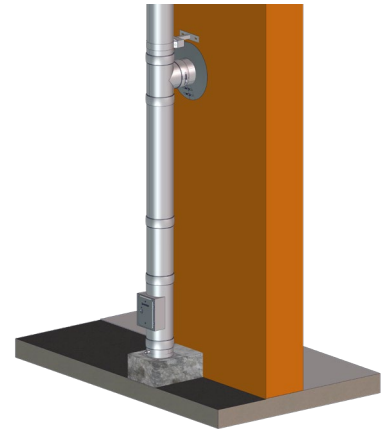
Aufbau mit Grundplatte für Sockelmontage
